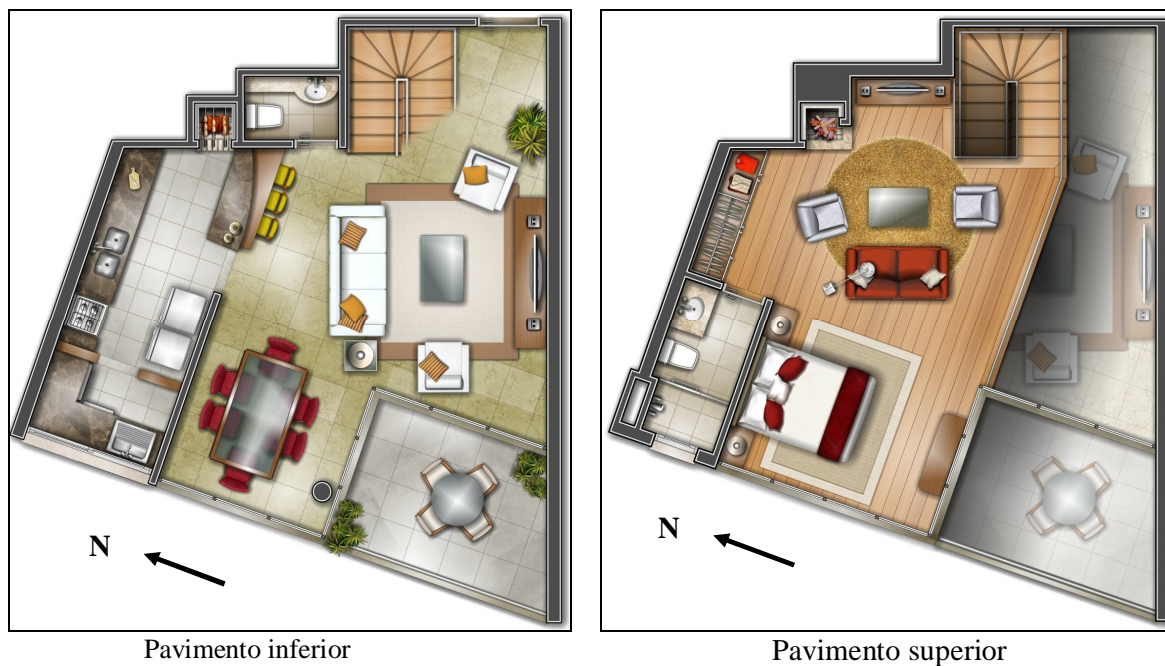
Planta baixa ilustrativa do pavimento inferior e superior da tipologia 03 (gf14)
